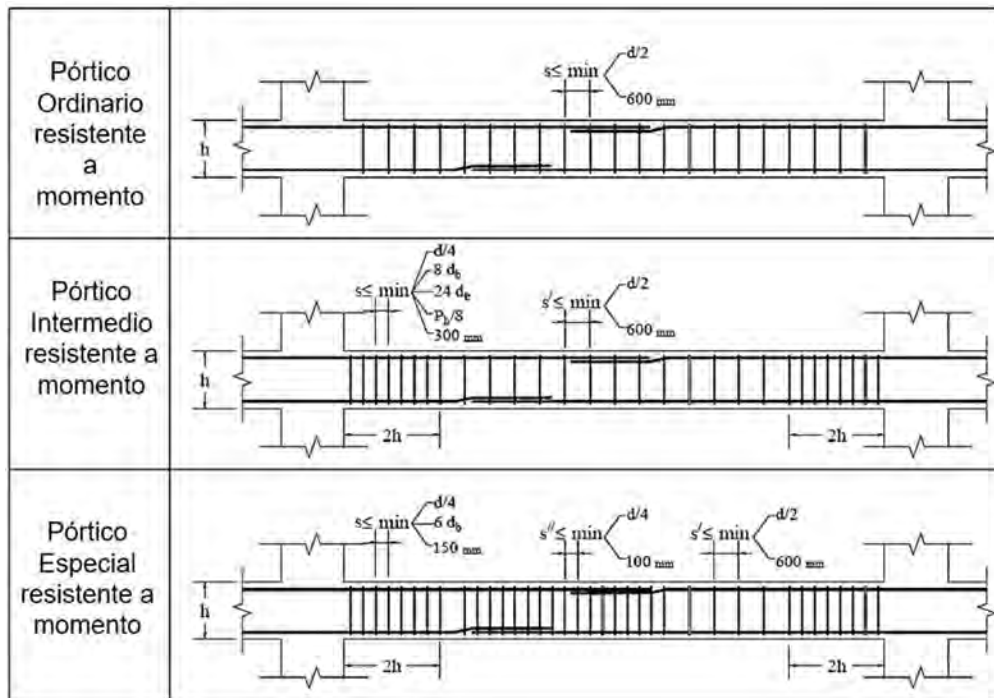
Criterio de refuerzo transversal de vigas para tres sistemas estructurales de acuerdo con el ACI 318-19 [11] [10]
